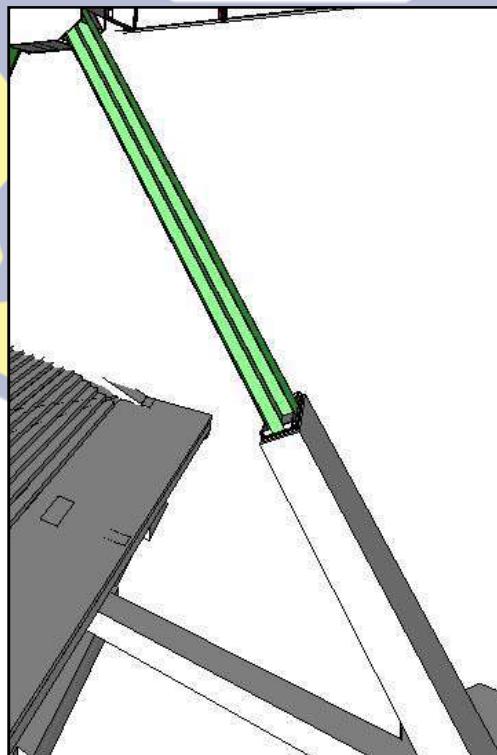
Denah gambar for construction kolom miring gedung auditorium
